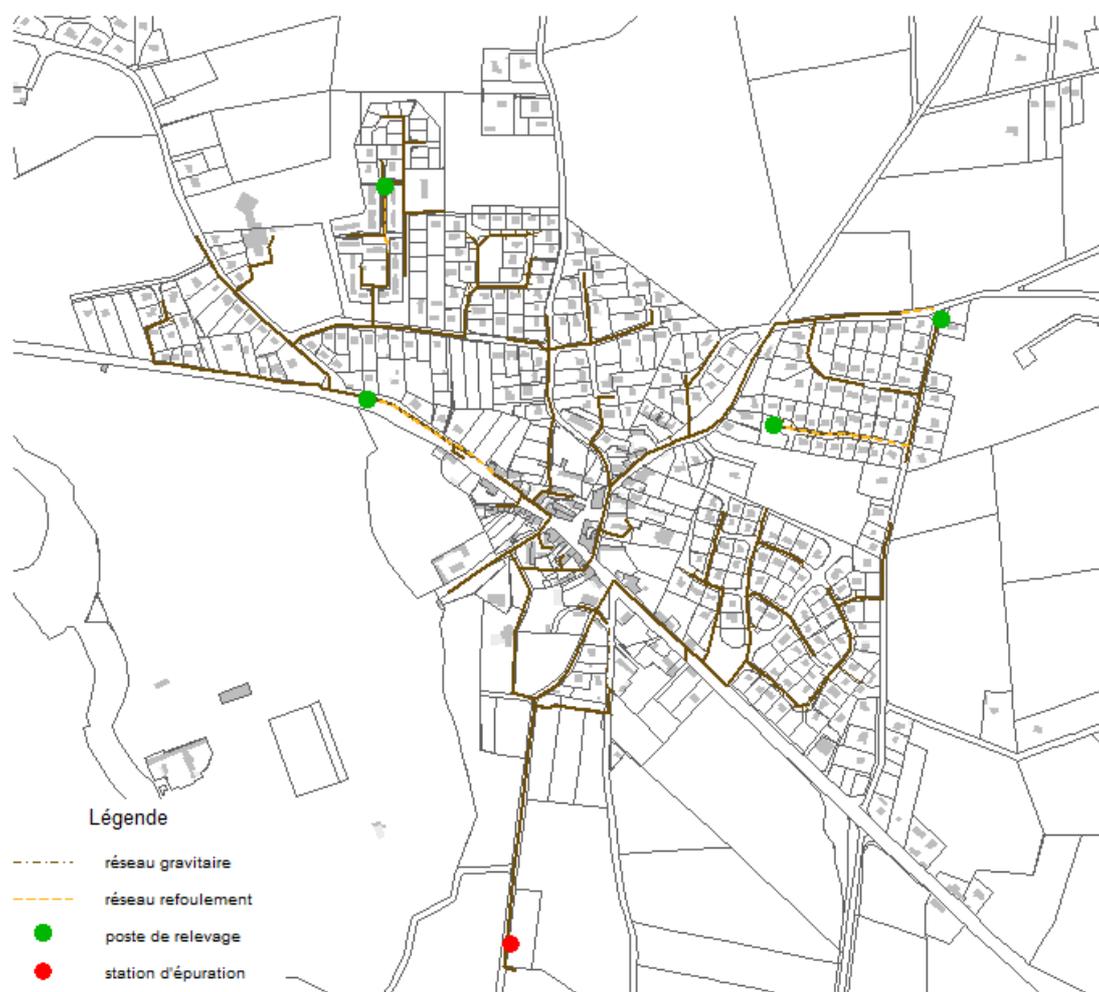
Plan des réseaux d'assainissement de la commune de Brandérion
